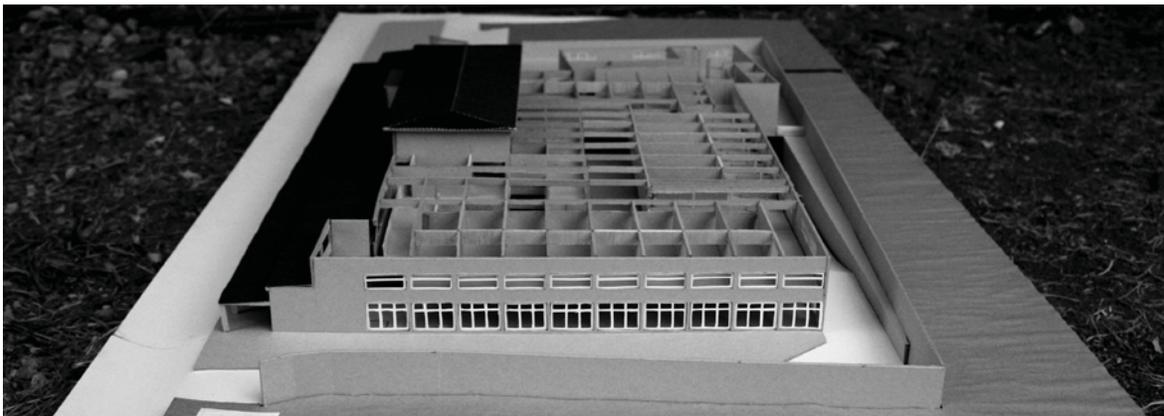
VISTA DE LA FACHADA ORIENTE DEL MERCADO.
